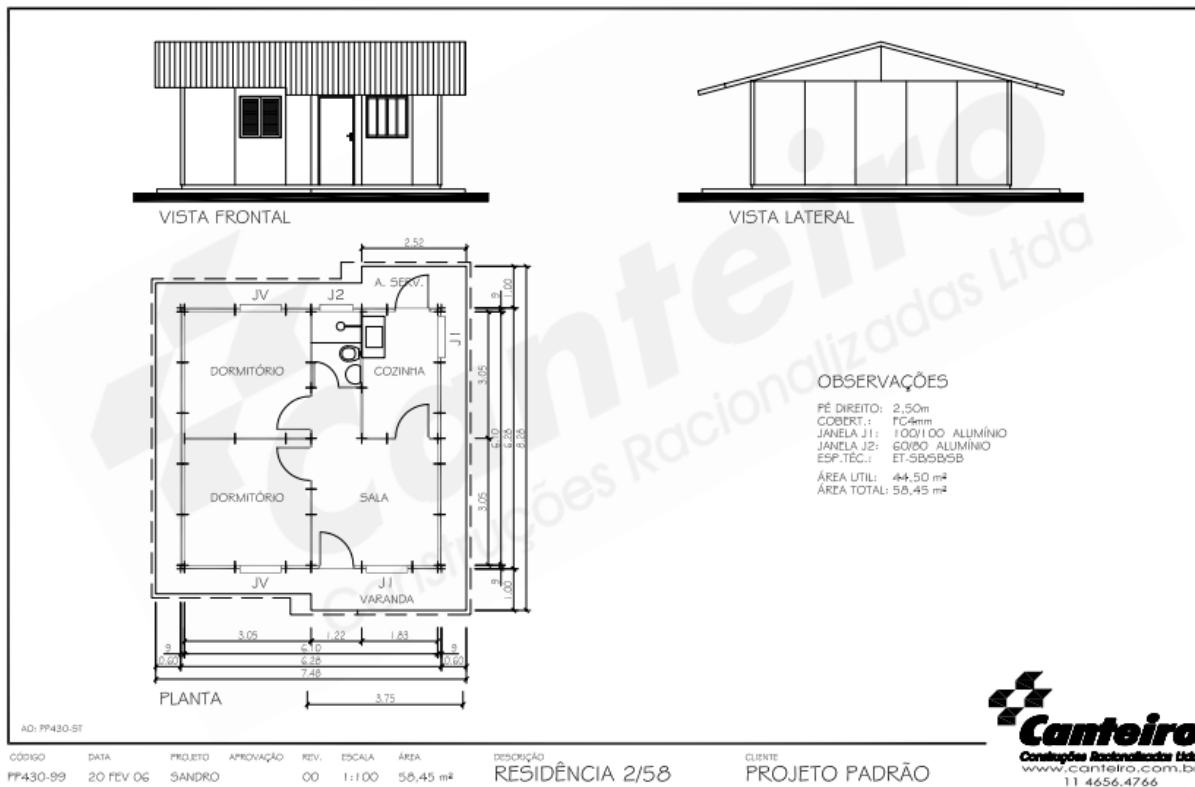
Alojamento tipo casa utilizado em canteiros.
